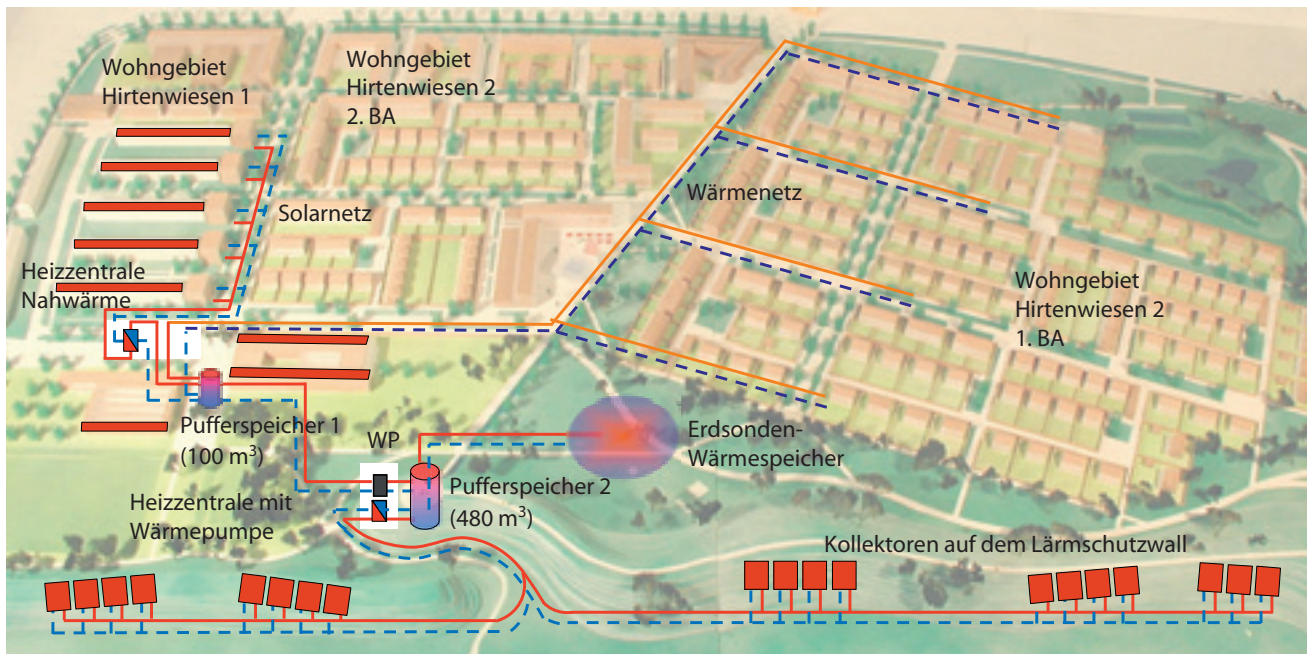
Lageplan der SuN mit saisonalem Wärmespeicher in Crailsheim
